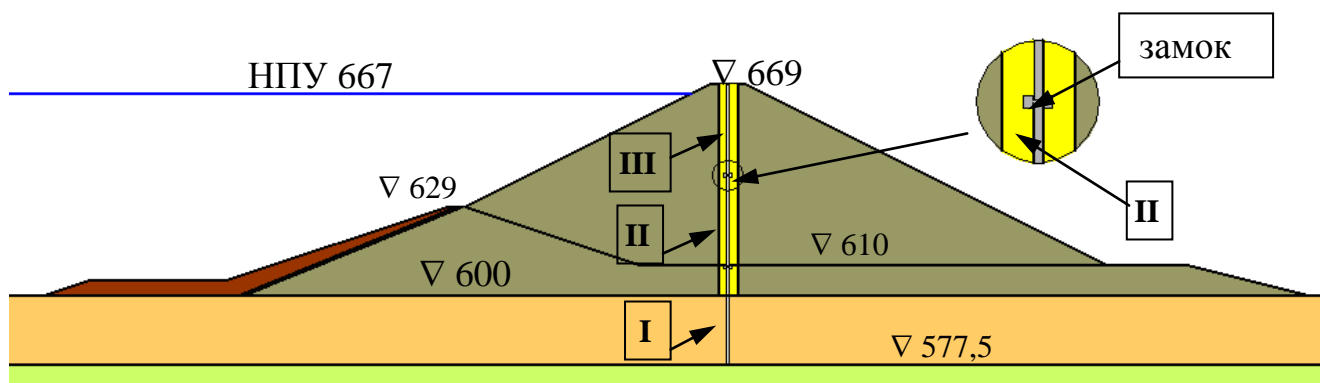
Конструкция высокой грунтовой плотины с диафрагмой, возведённой поярусно методом «стена в грунте». I, II, III – ярусы стены.
